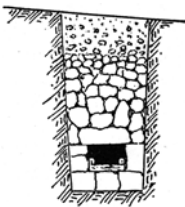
Sickerdohle mit eingebauter Holzrinne.
